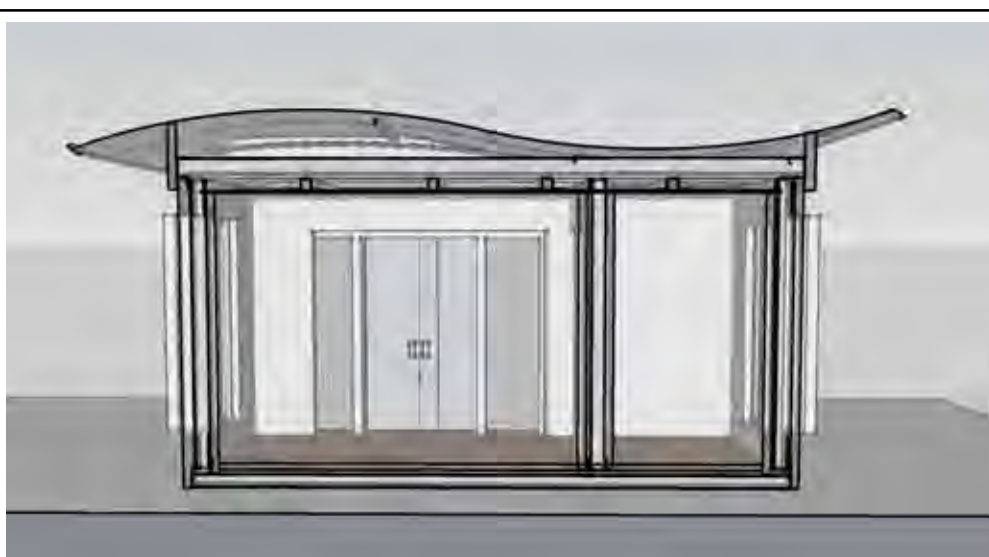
Corte Longitudinal.: Elaboración propia 2010
